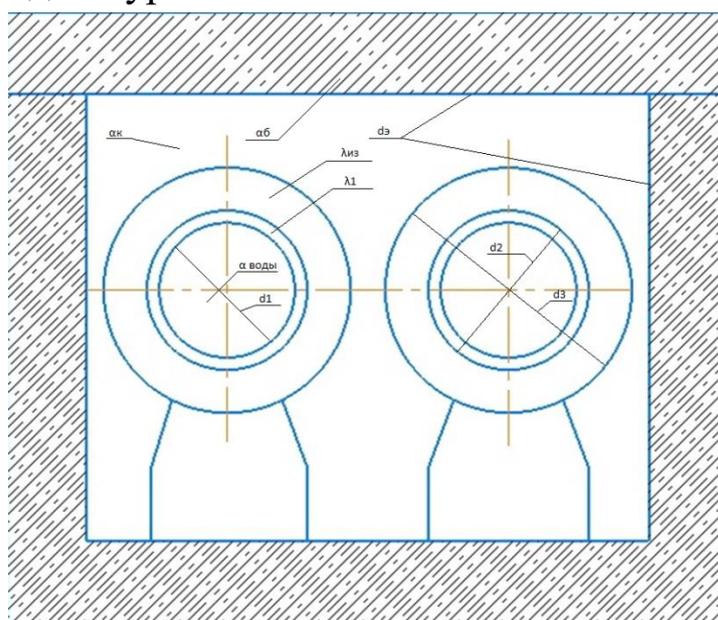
Расчетная схема трубопровода тепловой сети в канале подземной прокладки
